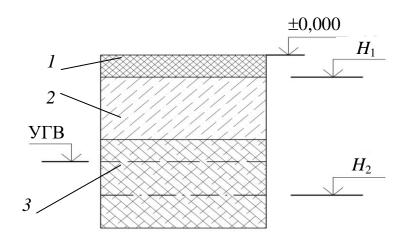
Геологический разрез строительной площадки: 1 – растительный слой; 2 – первый основной грунт; 3 – второй основной грунт; УГВ – уровень грунтовых вод
